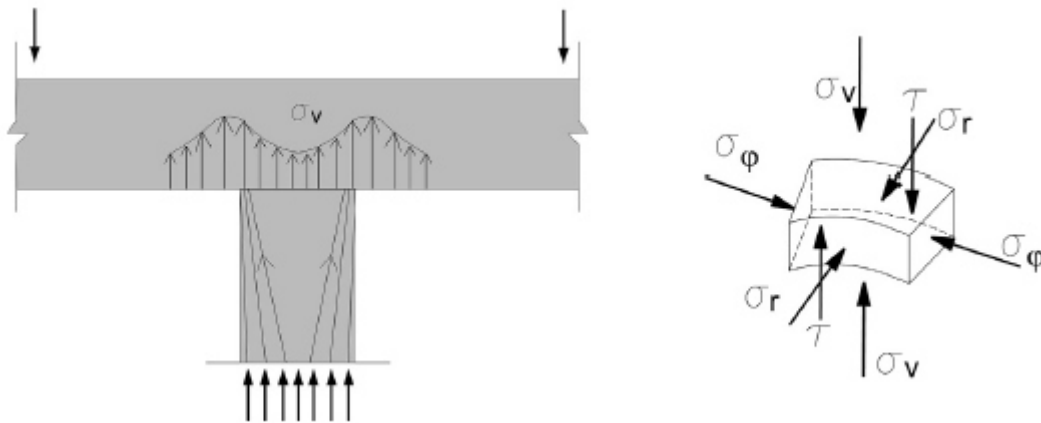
Esquema de las tensiones verticales en la zona inferior de la losa y estado tensional de un punto (Marí, Cladera, Oller, & Bairán, 2018).
